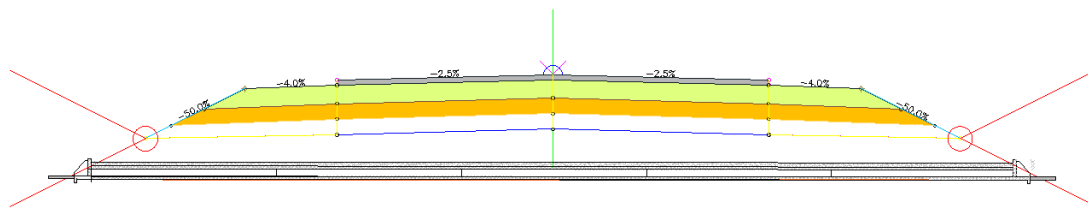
Profil en travers types ouvrage hydraulique
